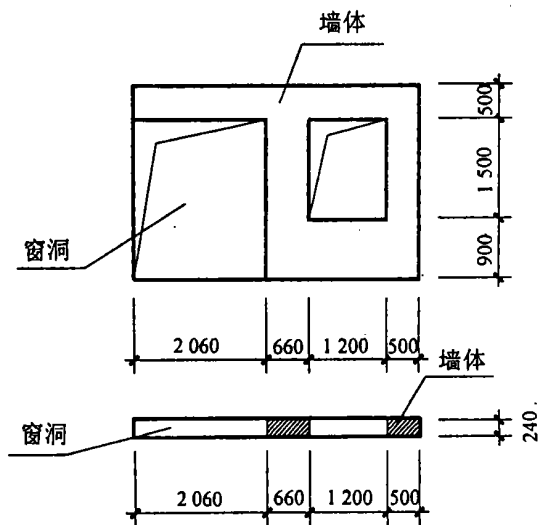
拆除计算单元墙体中卧室与阳台间墙体的平、立面图
